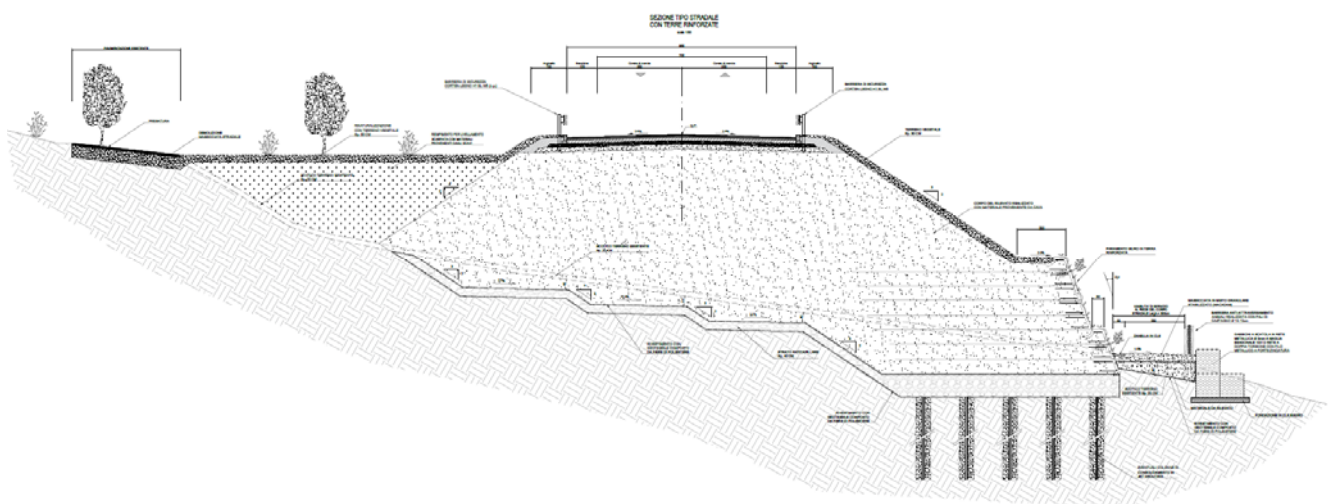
Sezione tipo dell'asse principale in un tratto in variante
